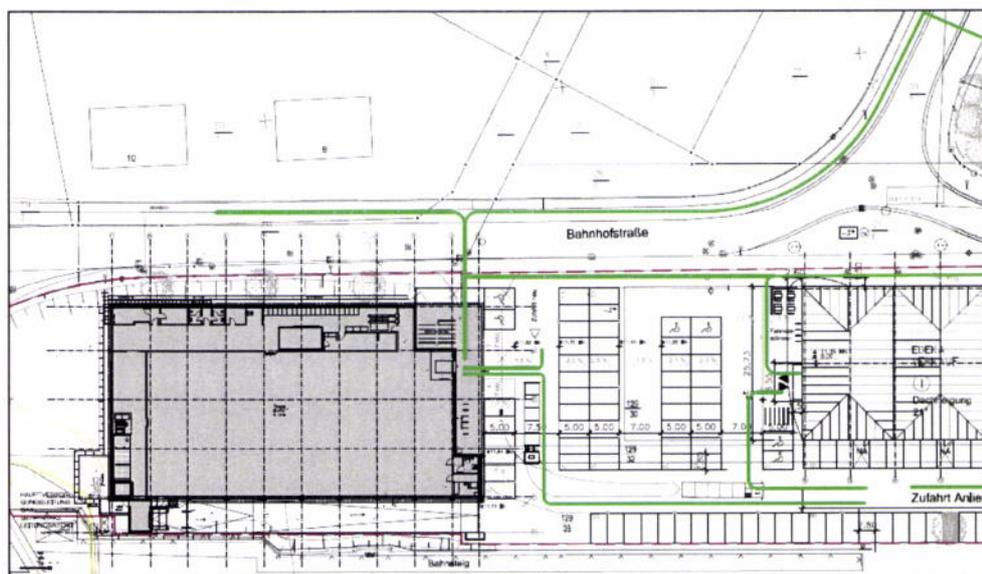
Geplante fußläufige Verbindungen (Grün)
